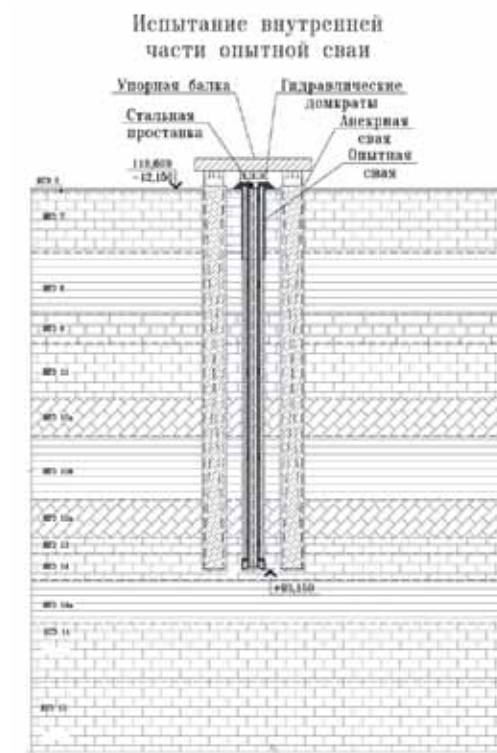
Схема испытания свай длиной 8,7 м и 9,8 м для 49-этажного здания
